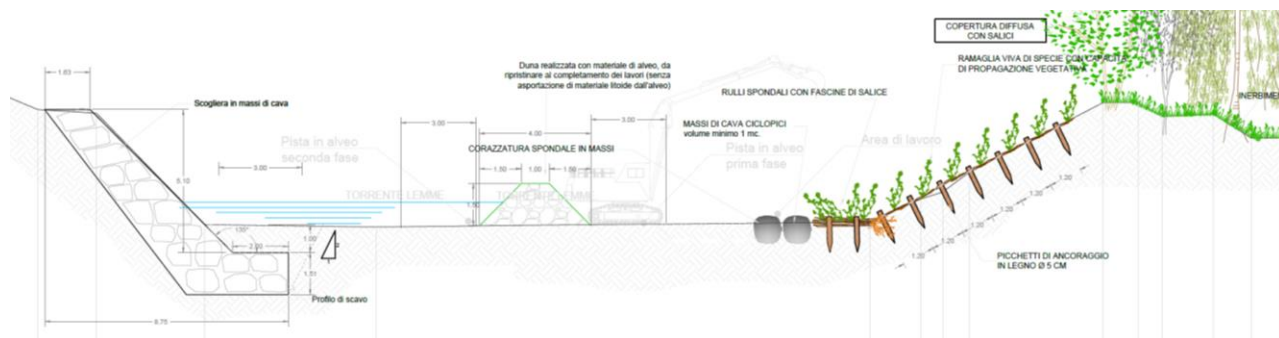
Fasi lavorative – Realizzazione sistemazione spondale – Sezione
